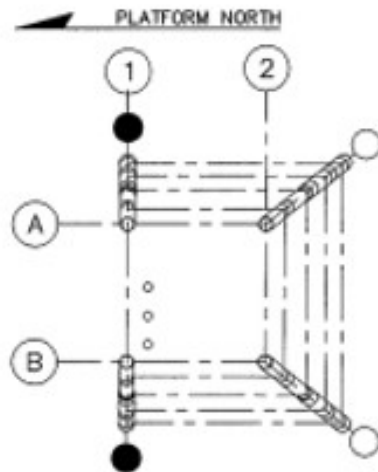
Grundriss der Tragkonstruktion.
